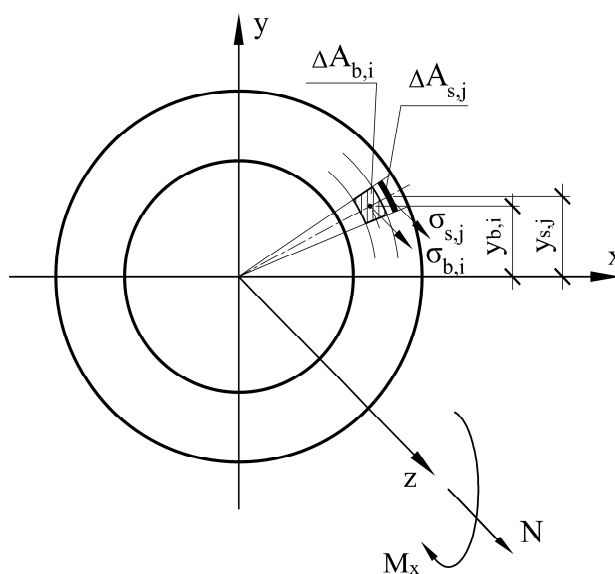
Схема сечения с изображением фрагментов бетона и арматуры
